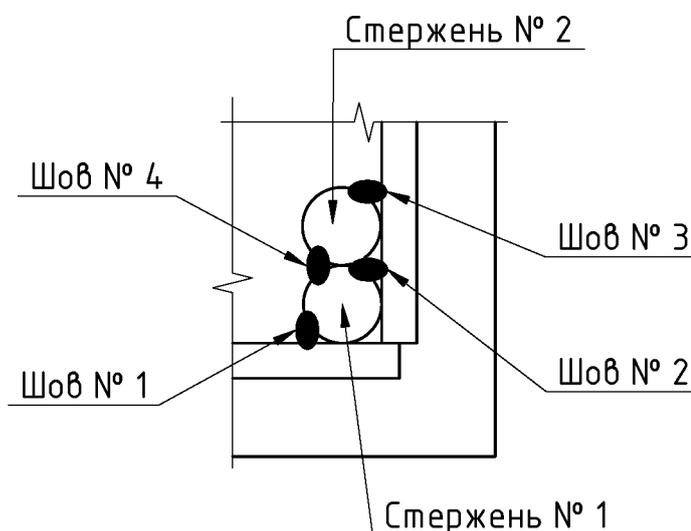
Схема приварки арматурных стержней к закладным деталям М6
